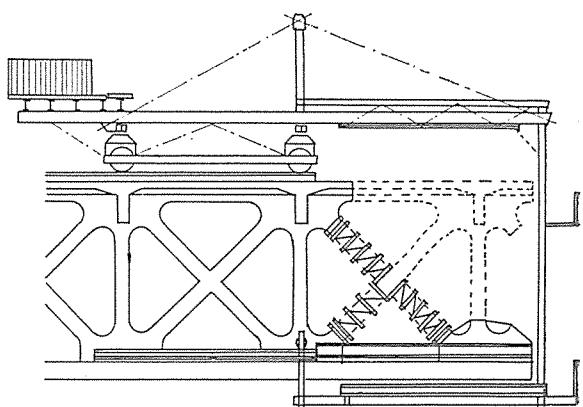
Mangfall Brücke のコンクリート打設法 (D & W 社資料より)
